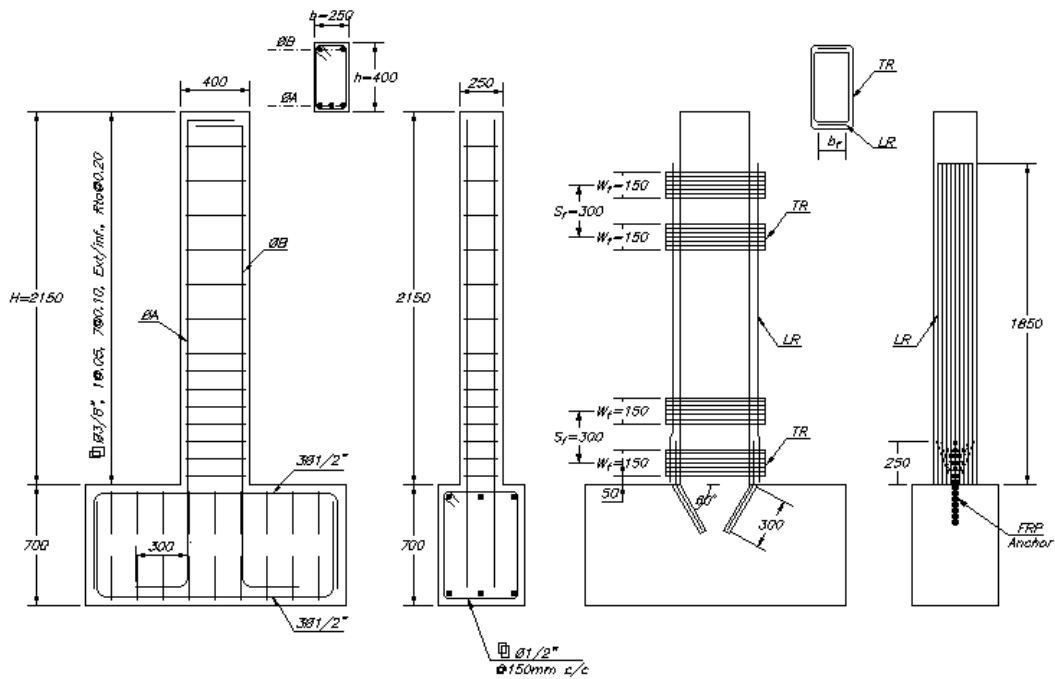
Detalle del reforzamiento interno y externo de vigas VE (Fuente: Bazán et al., 2020)
